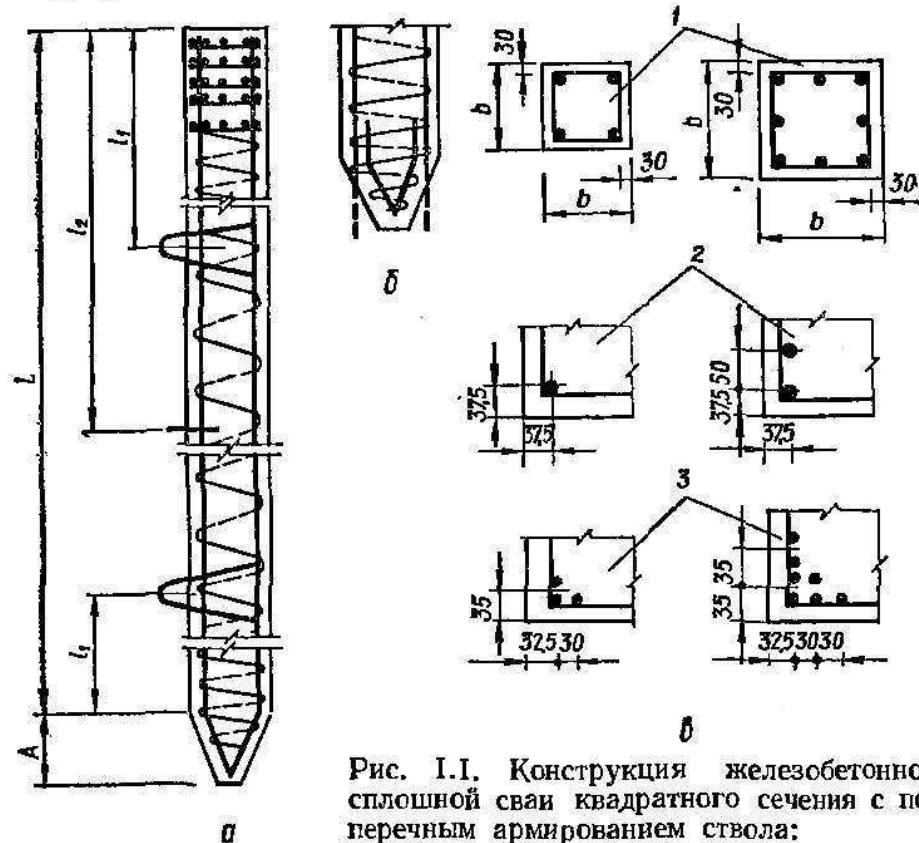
Конструкция железобетонной сплошной сваи квадратного сечения с поперечным армированием ствола:
